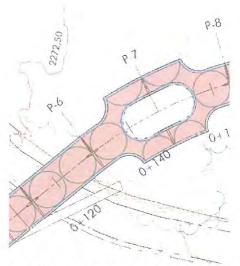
Vista en planta de la ubicación de las columnas y disposición de trabes en todo el perímetro.
